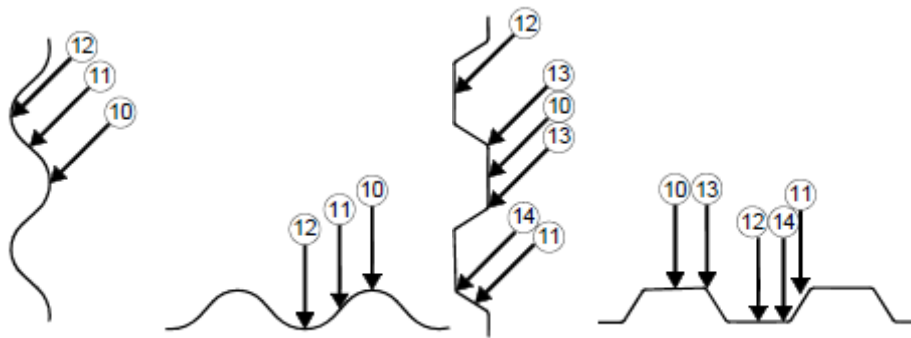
Beschussorte für profilierte Faserzementelemente (links für den Einsatz auf dem Dach, rechts Fassadeneinsatz)
